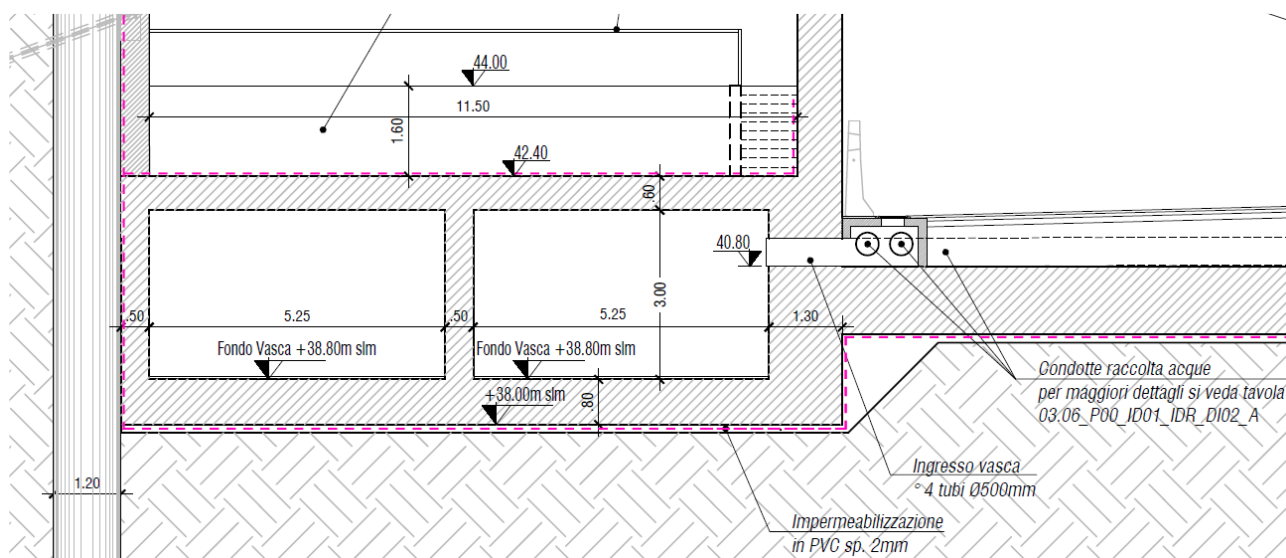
Sezione e pianta della vasca di sollevamento e laminazione
